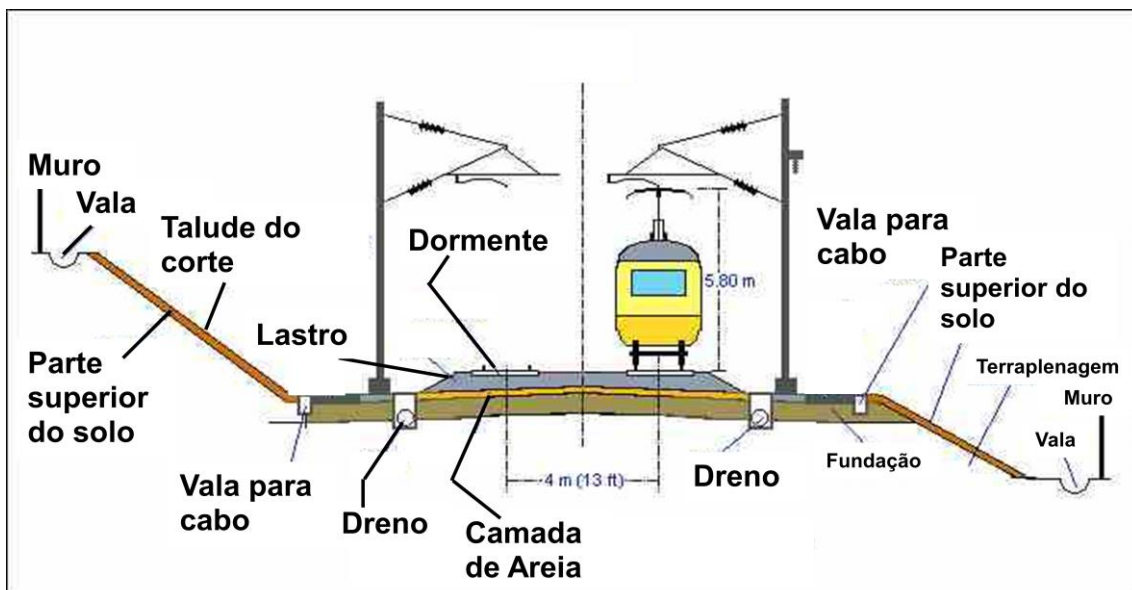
Infra e Superestrutura Ferroviária Eletrificada
